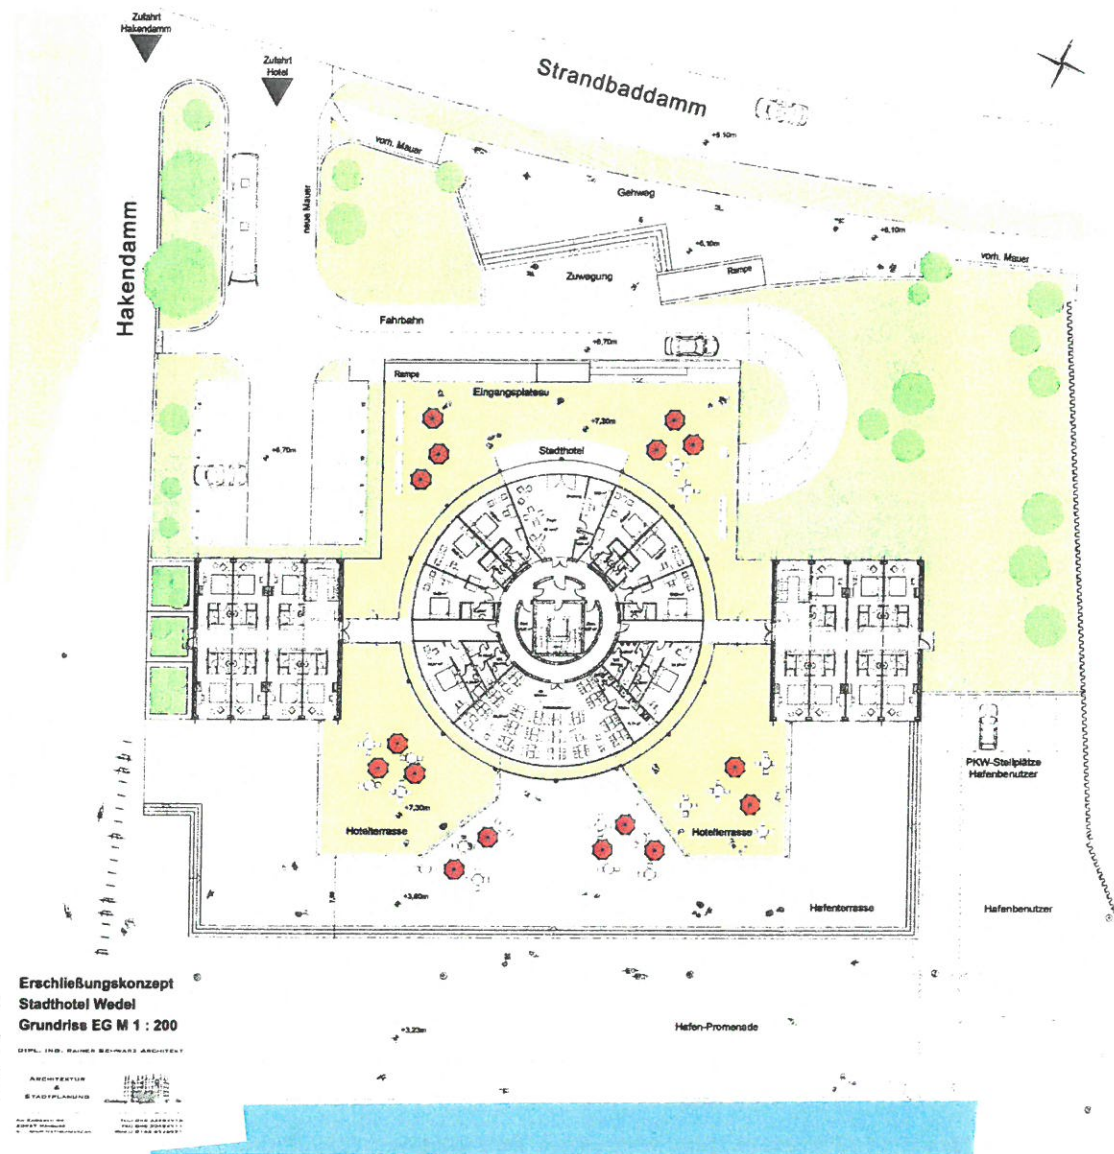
Grundriss Hotel Stadthafen Wedel, Stand 23.11.2016
